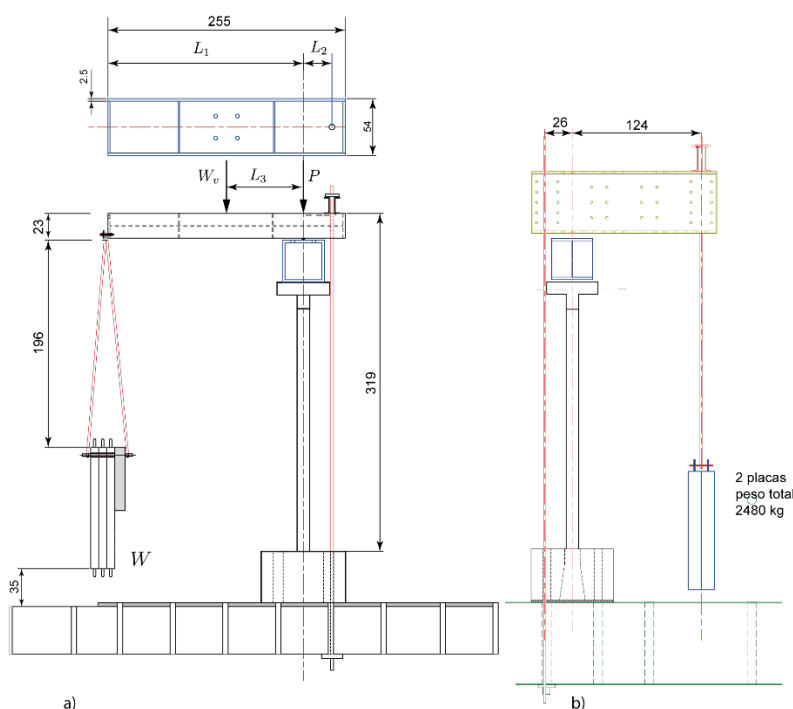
Sistema de carga vertical a) Instituto de Ingeniería, muros MH8R1-MH8R3 y b) CENAPRED muro MH8R4.
